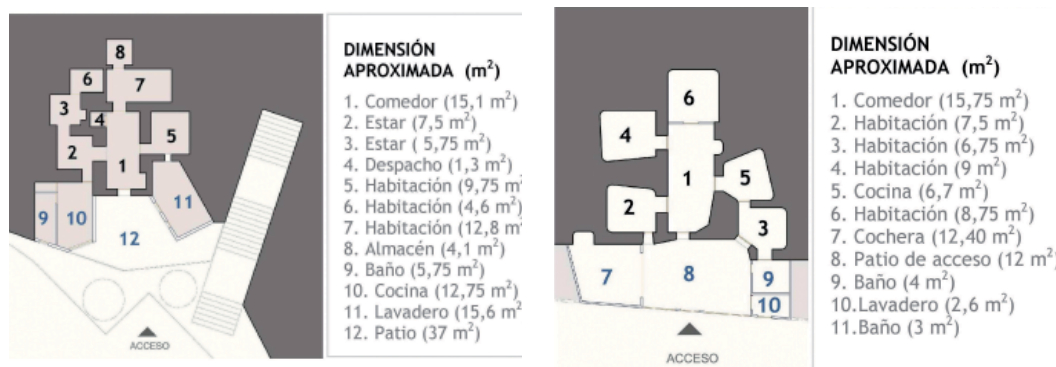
Tipología de Cueva+ Construcciones Anexas. Izqda.: Planta de vivienda ubicada en la calle Vaiona nº 19. Dcha.: Planta de vivienda ubicada en la calle Taibilla nº1. (Dibujos: B. Piedecausa).
